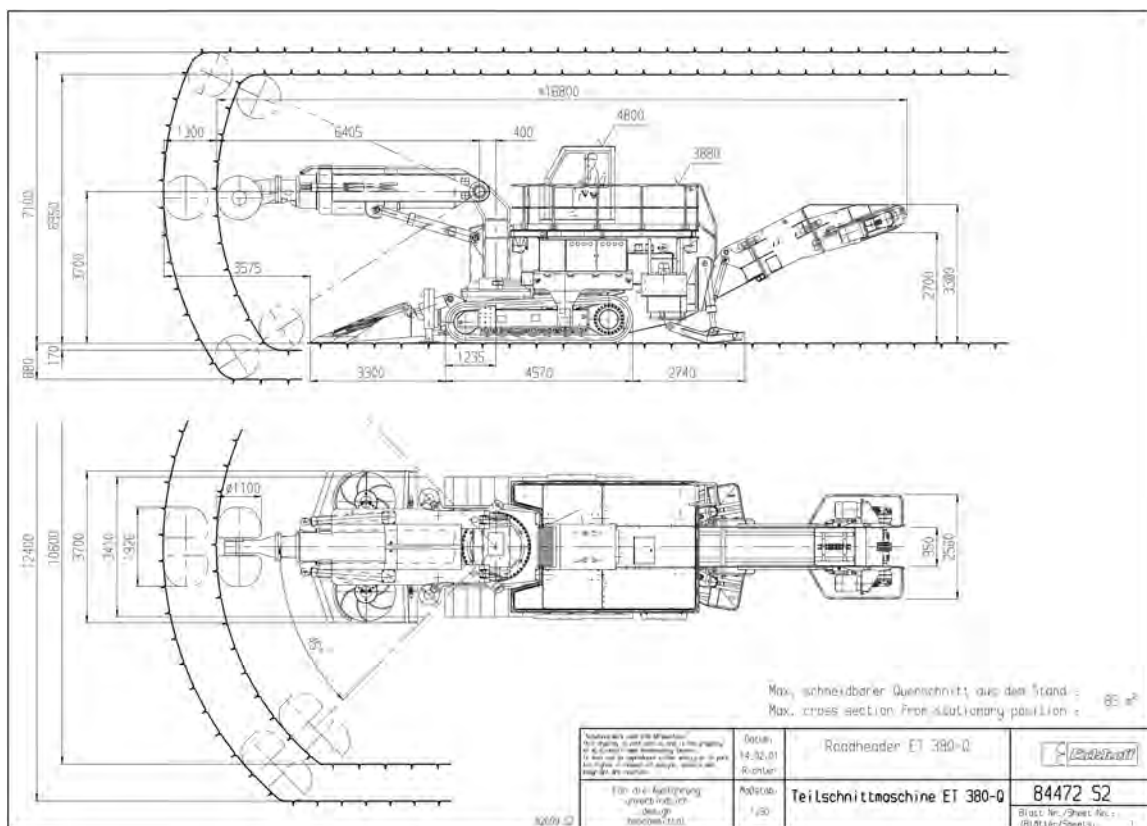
Données techniques d'une machine à attaque ponctuelle, type ET 380-Q
